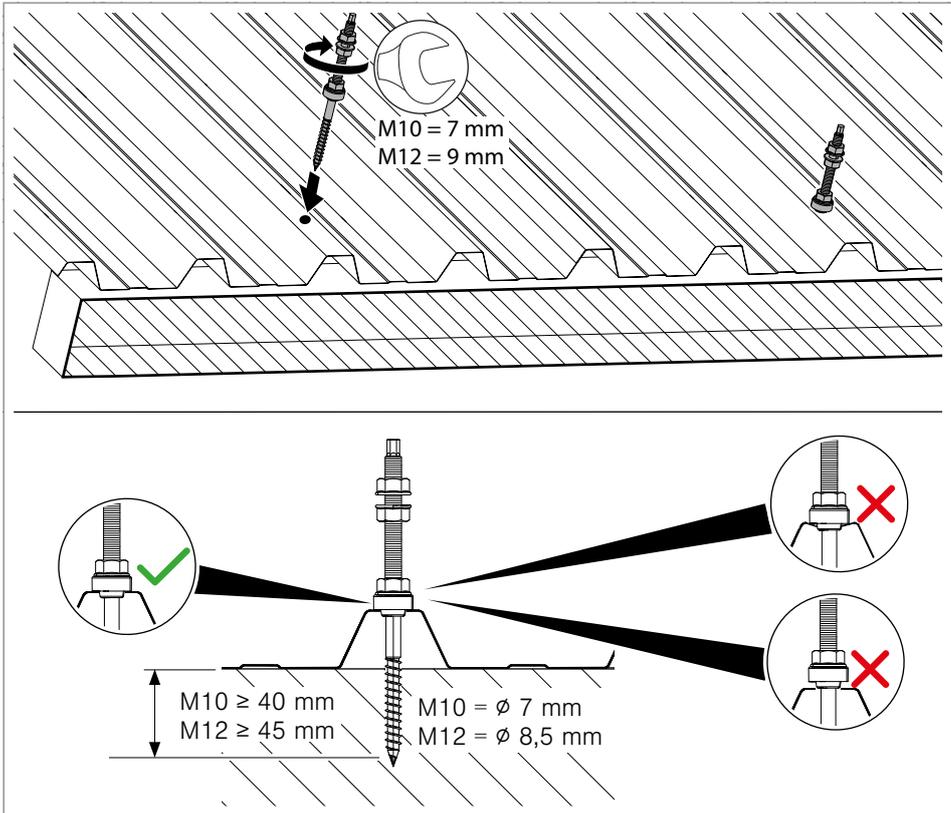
Stockschraube eindrehen (richtig/falsch)
